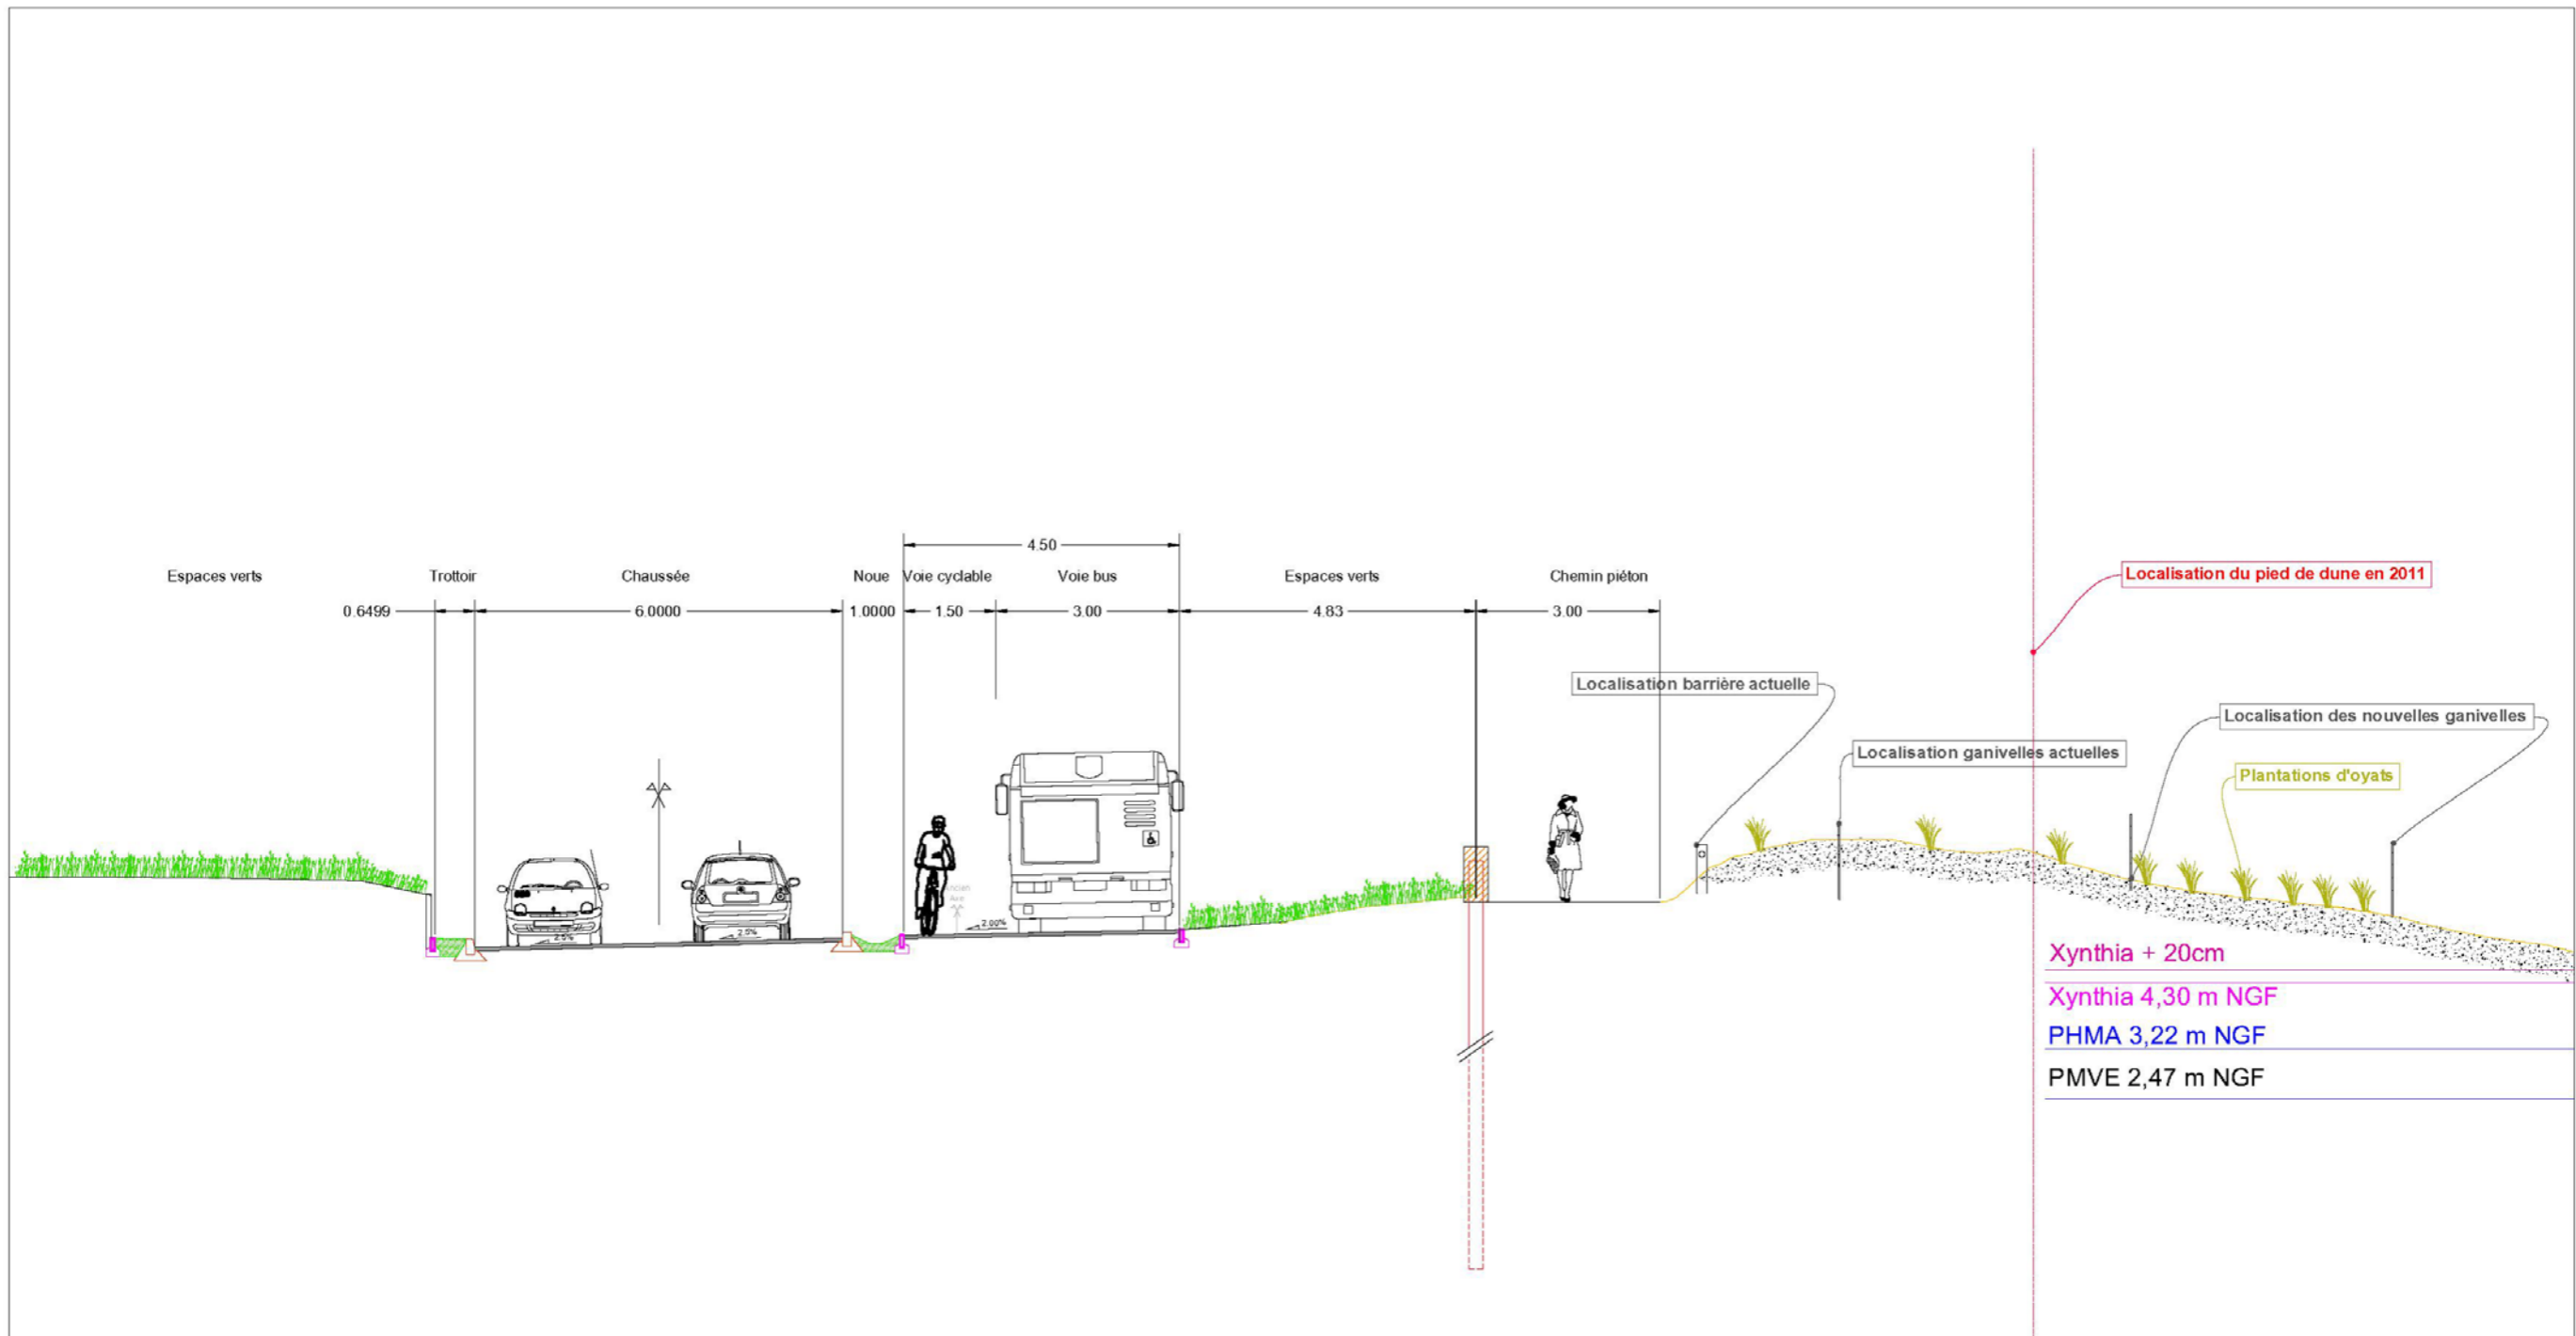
Coupe type de la protection de la RD201 avec un muret fondé par un rideau en palplanches (Coupe BB)
